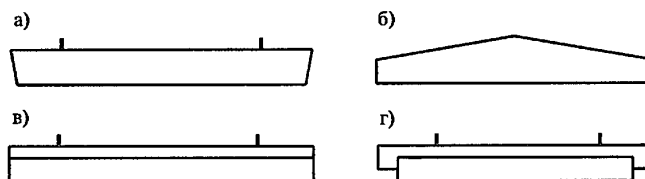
Вид железобетонных балок в зависимости от опирания на нижележащие конструкции: а); б) на кирпичные стены или консоли колонн сверху; в) на верхний торец (обрез) колонны или верх стены; г) на консоль колонны — подрезкой, скрывающей консоль
